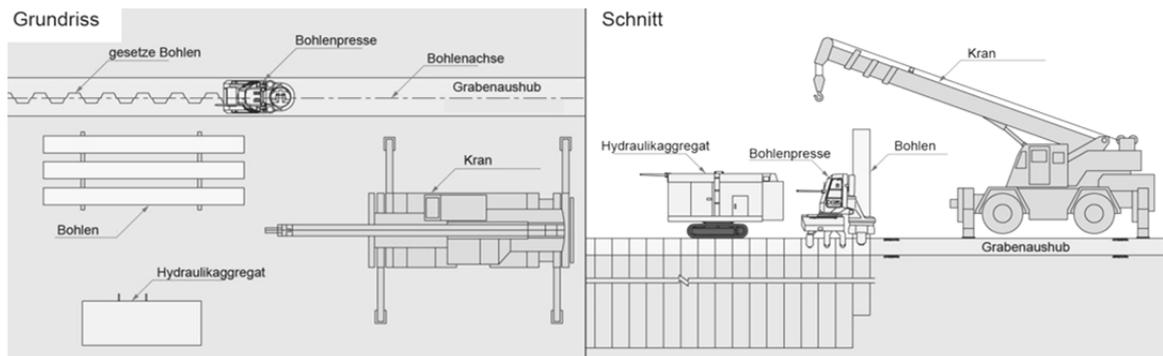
Baustelleneinrichtung Spundbohlenpresse [15]
